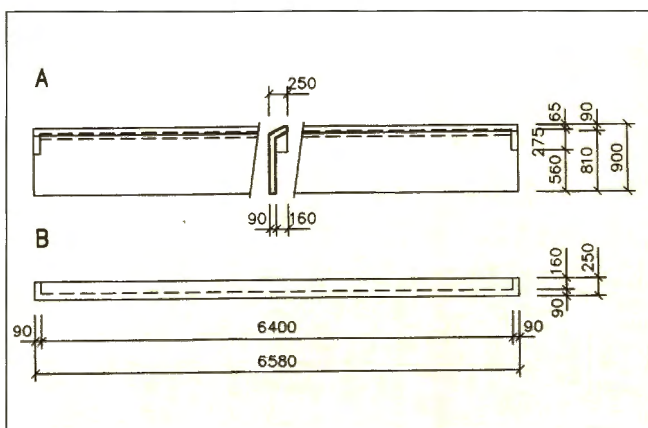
Rámová příčle A – boční pohled, B – půdorys / Frame beam with console A – side view B – ground plan
